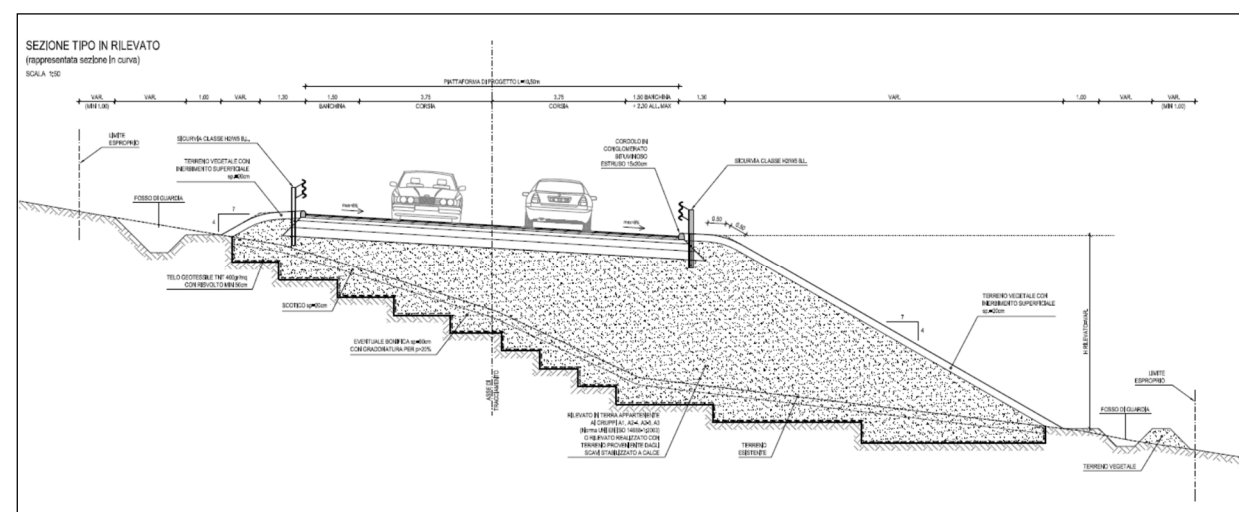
Esempio di sezione trasversale tipica dell'asta principale
